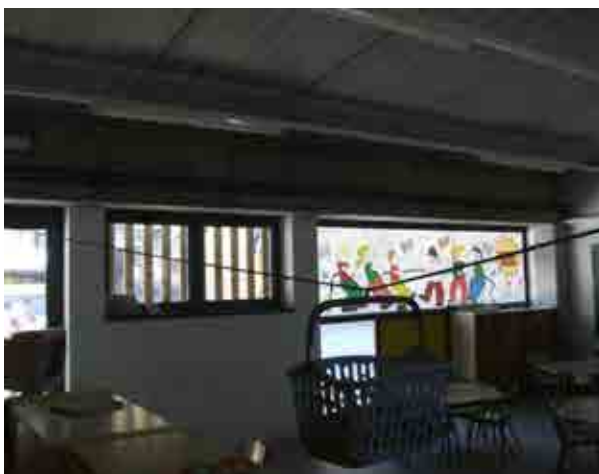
1-30 Distribución de pilares en salones - posibilidad de columna corta
